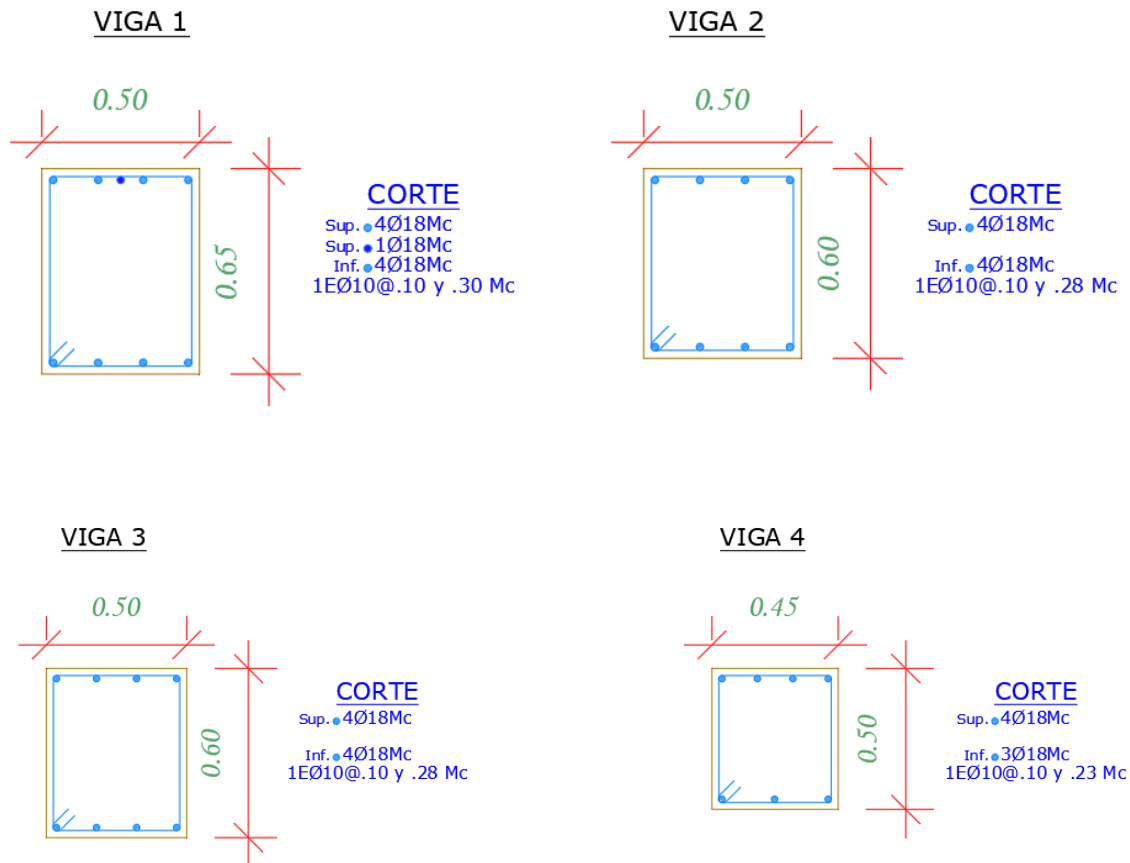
Secciones transversales de las vigas utilizadas en un edificio de 4 pisos para $\Delta_M = 0.5\%$.
